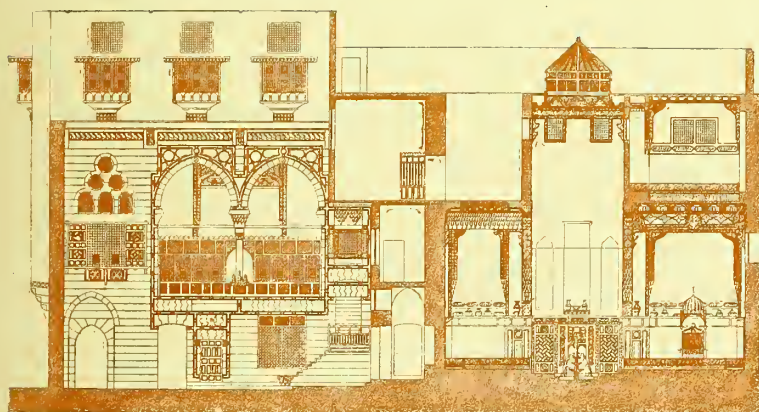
PLANTA DE UNA CASA EN EL BARRIO HAUCH-KADAN
